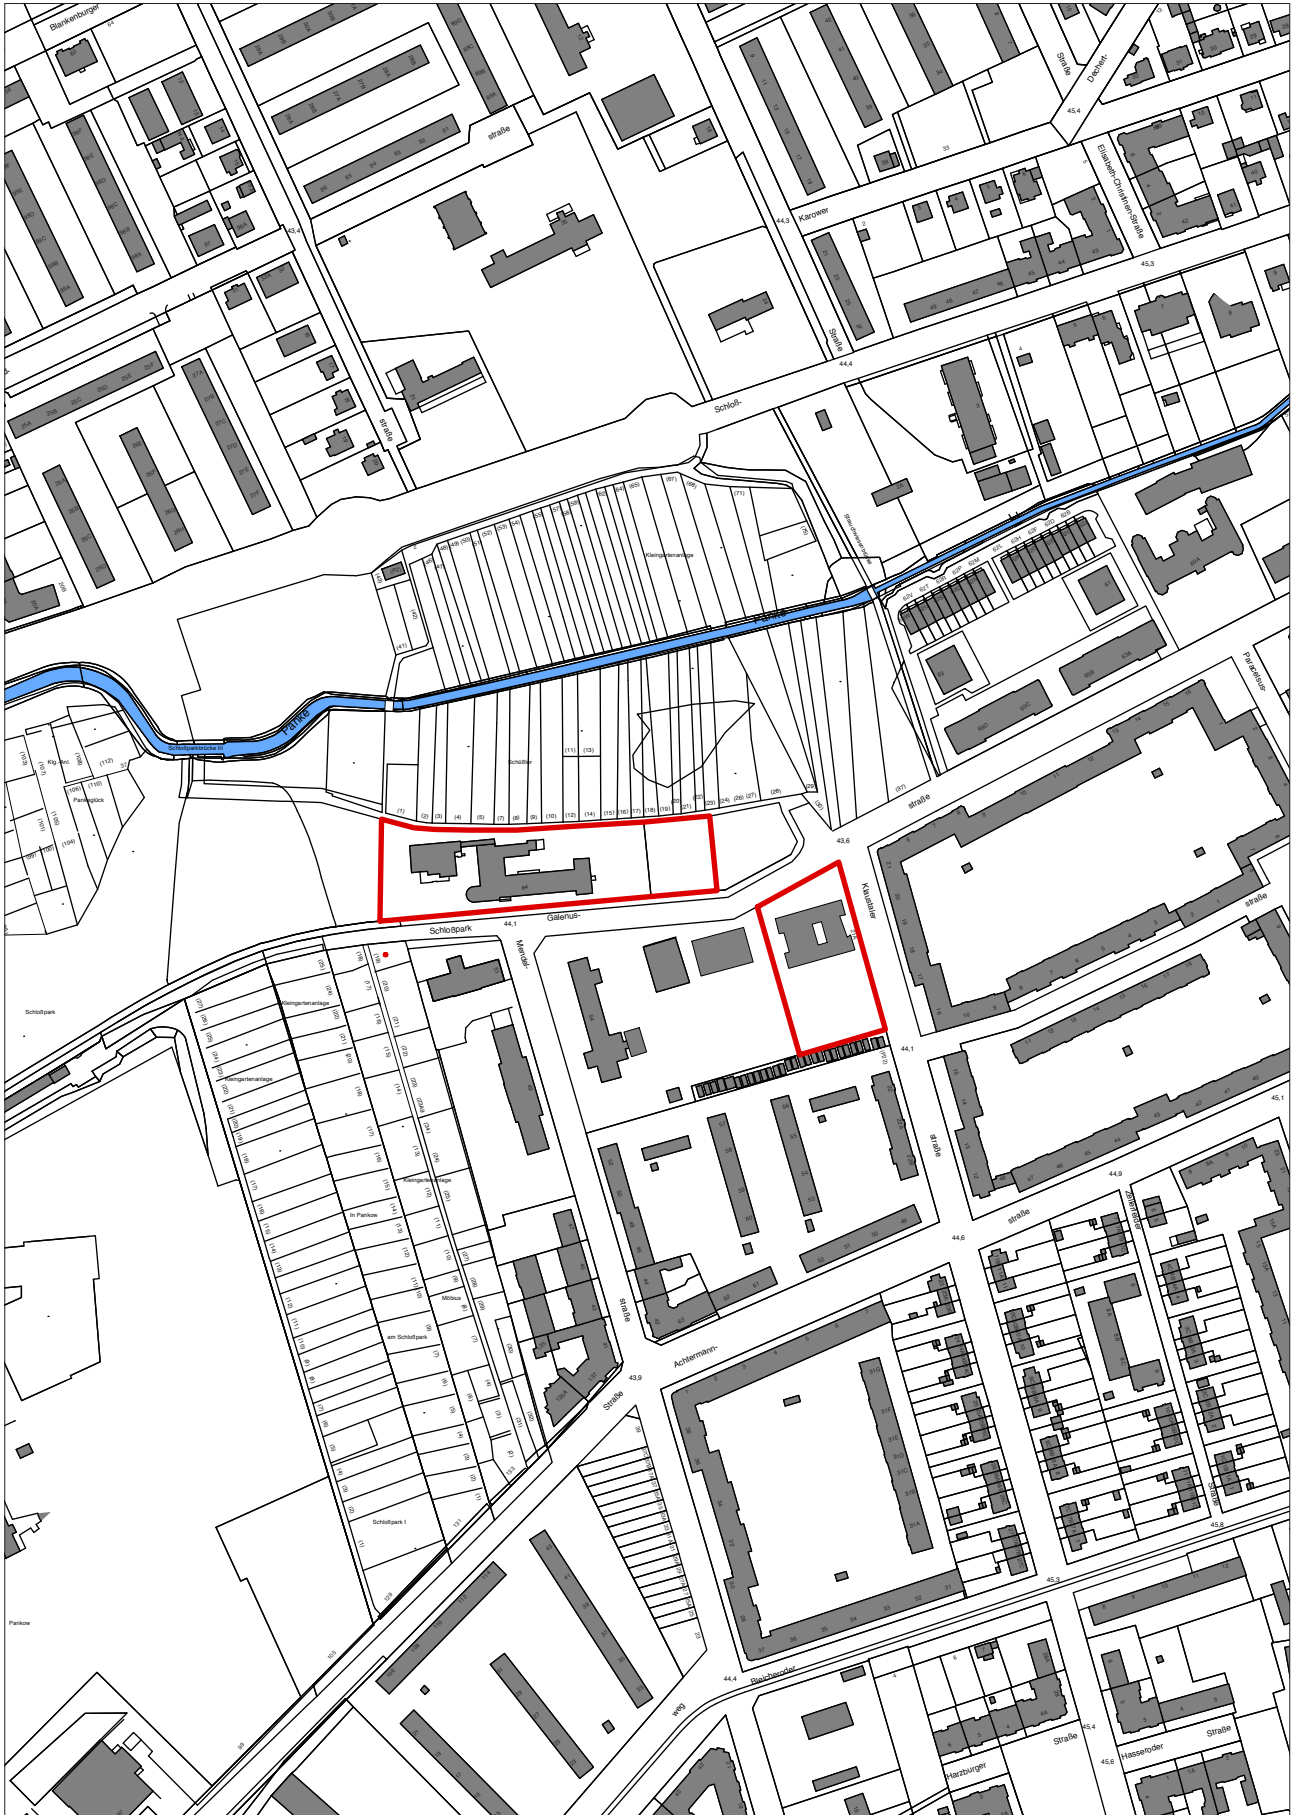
Lageplan mit Eintragung der Wettbewerbsbereiche im M. 1: 4.000
